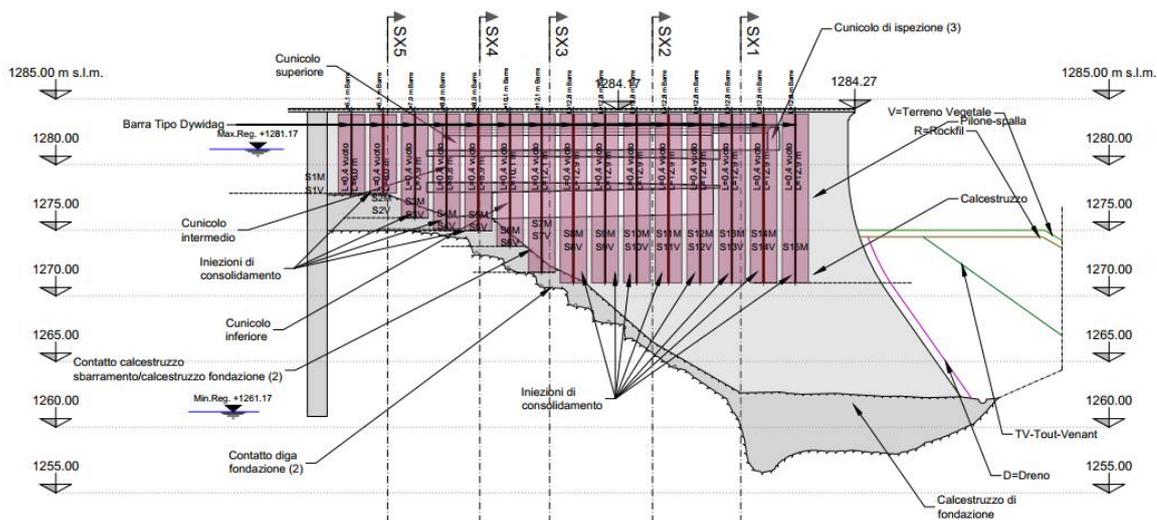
Iniezioni dal coronamento dello sbarramento secondario, sezione longitudinale
